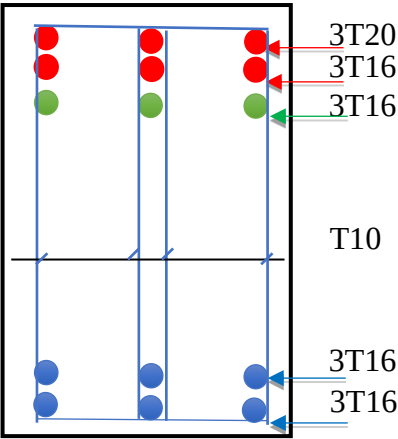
Ferrailage de la poutre de libage (sens transversal)
